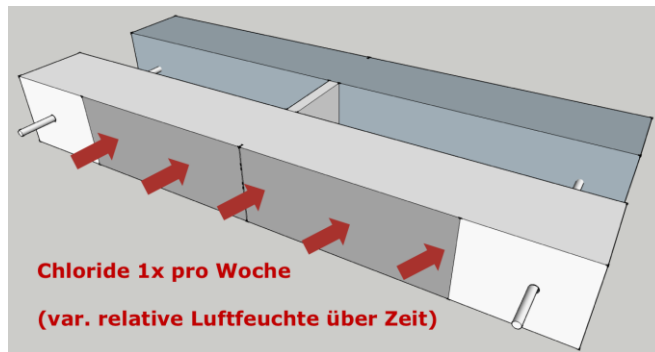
Bewehrte Betonbalken mit Biegerissen und eine mittig platzierte Korrosionsstelle (segmentierter Stahl mit C-Stahl Anode im Rissbereich und nichtrostender Bewehrung in allen anderen Bereichen).
